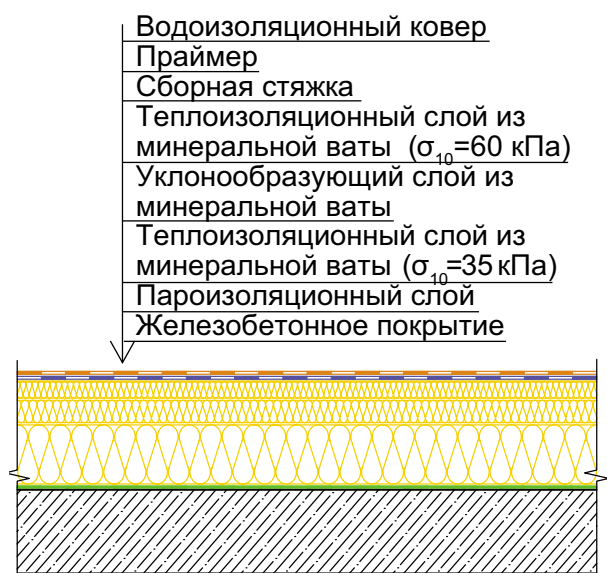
Кровля с теплоизоляцией из минераловатных плит по железобетонному покрытию
